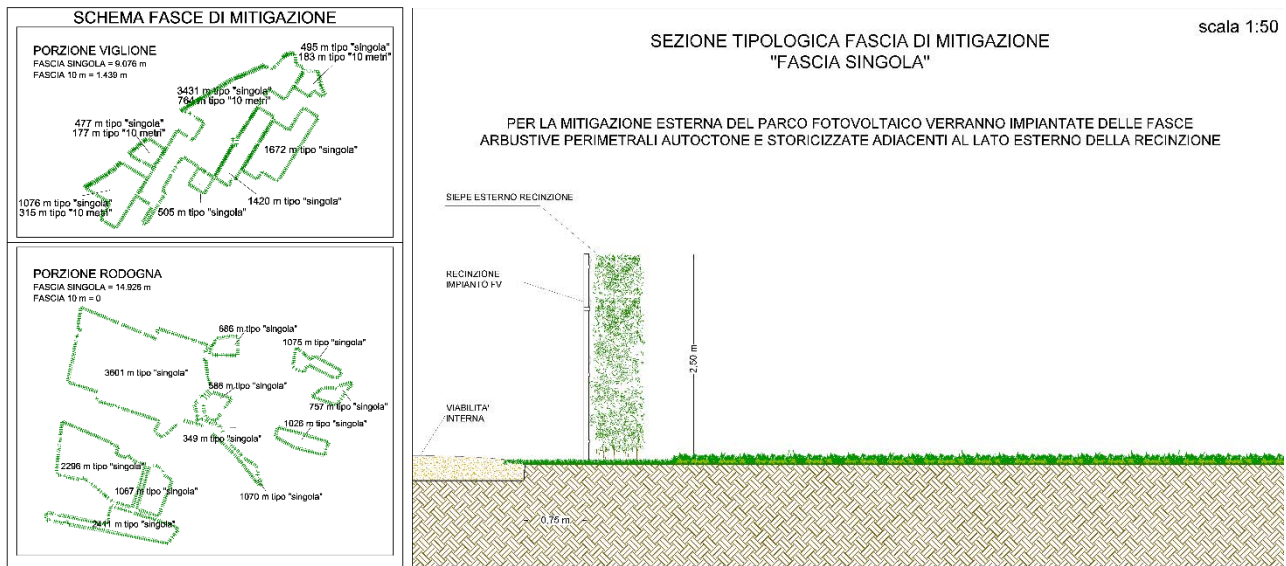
Schema delle opere di mitigazione visuale di tipo 'singola' (siepe) previste per tutti i confini dell'area di impianto.
